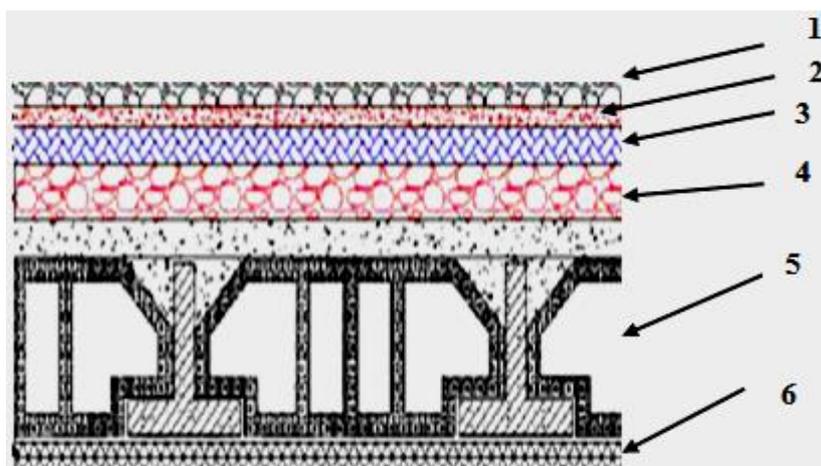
coupe d'un plancher à corps creux du plancher terrasse
